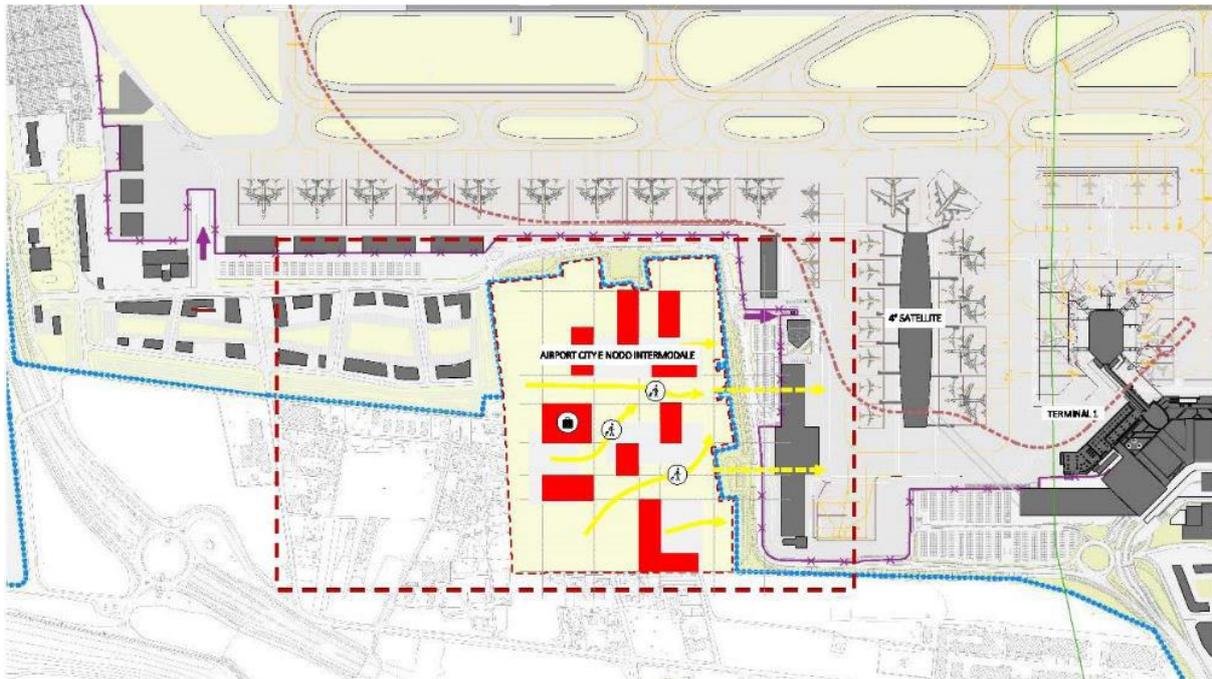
Ipotesi 3 – schema di layout fonte: Masterplan 2035
